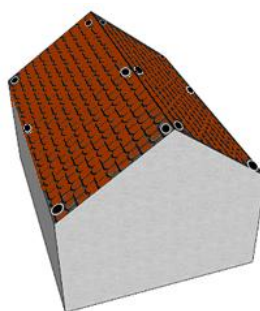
LOCALIZAÇÃO DOS PONTOS EM CADA PLANO DOS TELHADOS ADJACENTES
